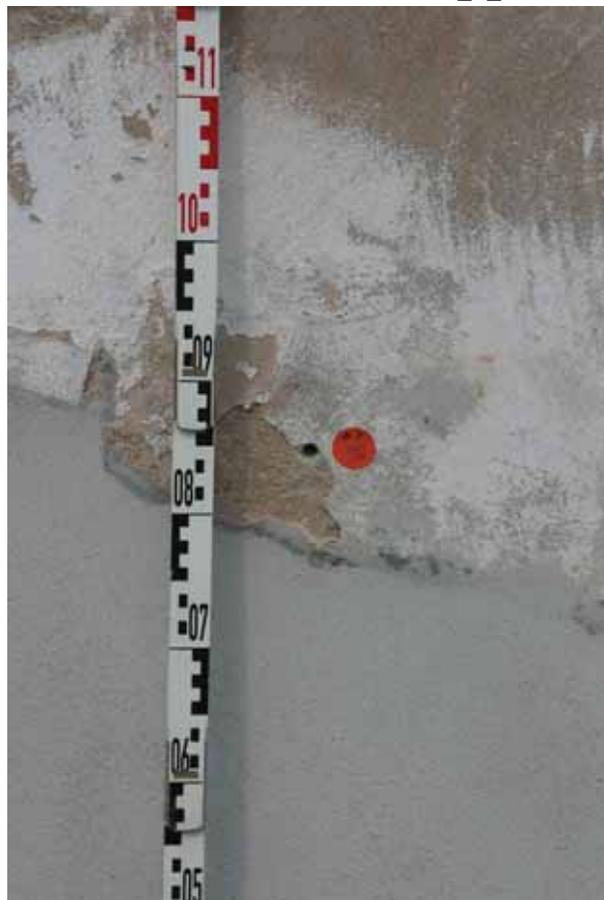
Beamtenhaus, Südwestfassade, M_K_TP2
